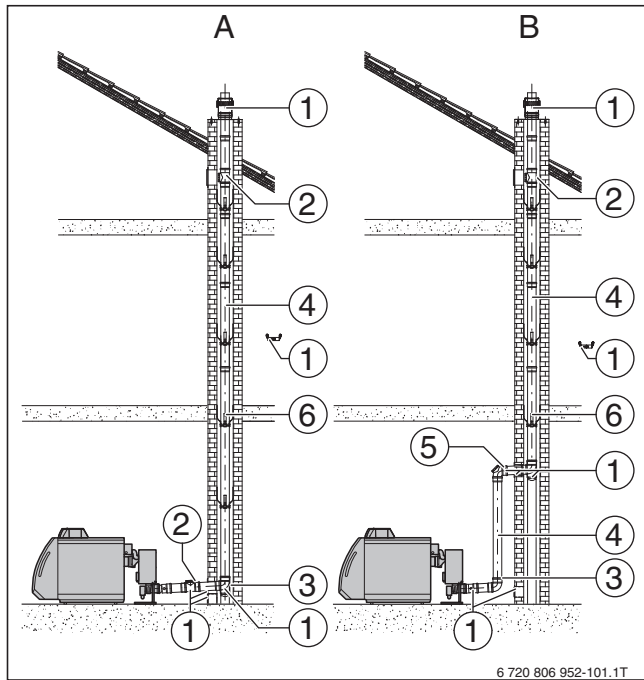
Abgasanlagen zur Schachtinstallation Variante 1 und Variante 2
